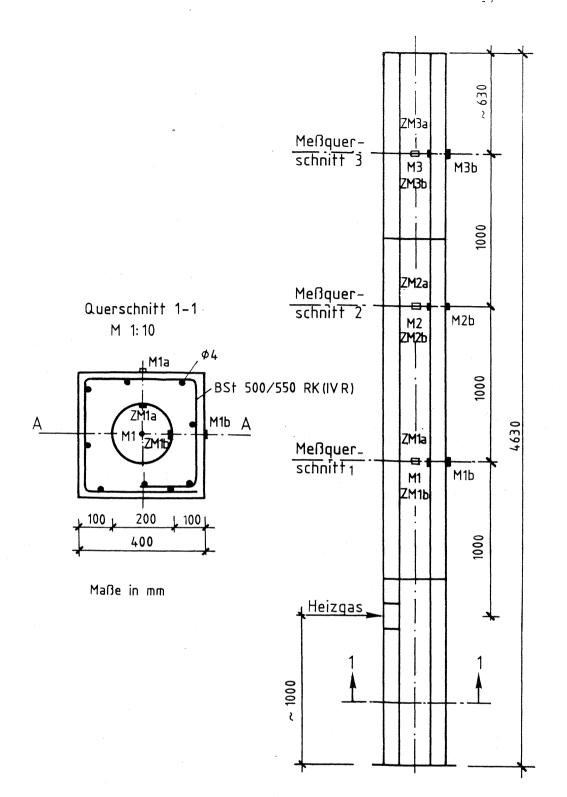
Prüfschornstein und Lage der Thermoelemente [21]
